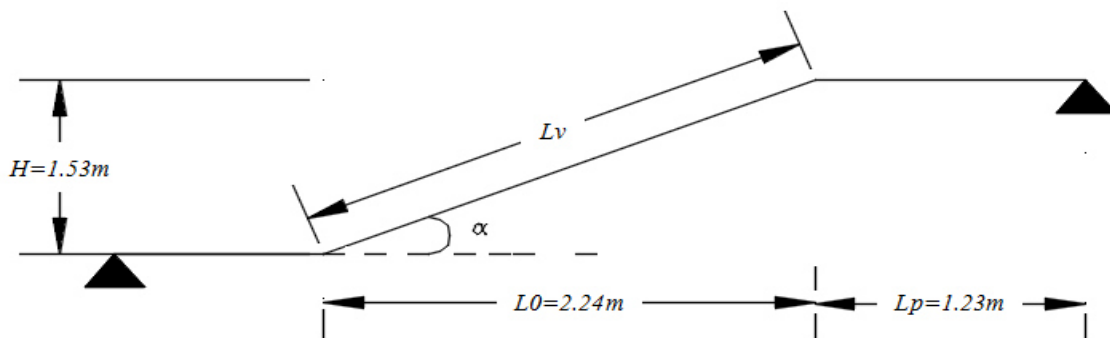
Coupe en élévation de l'escalier droit à deux volées.
